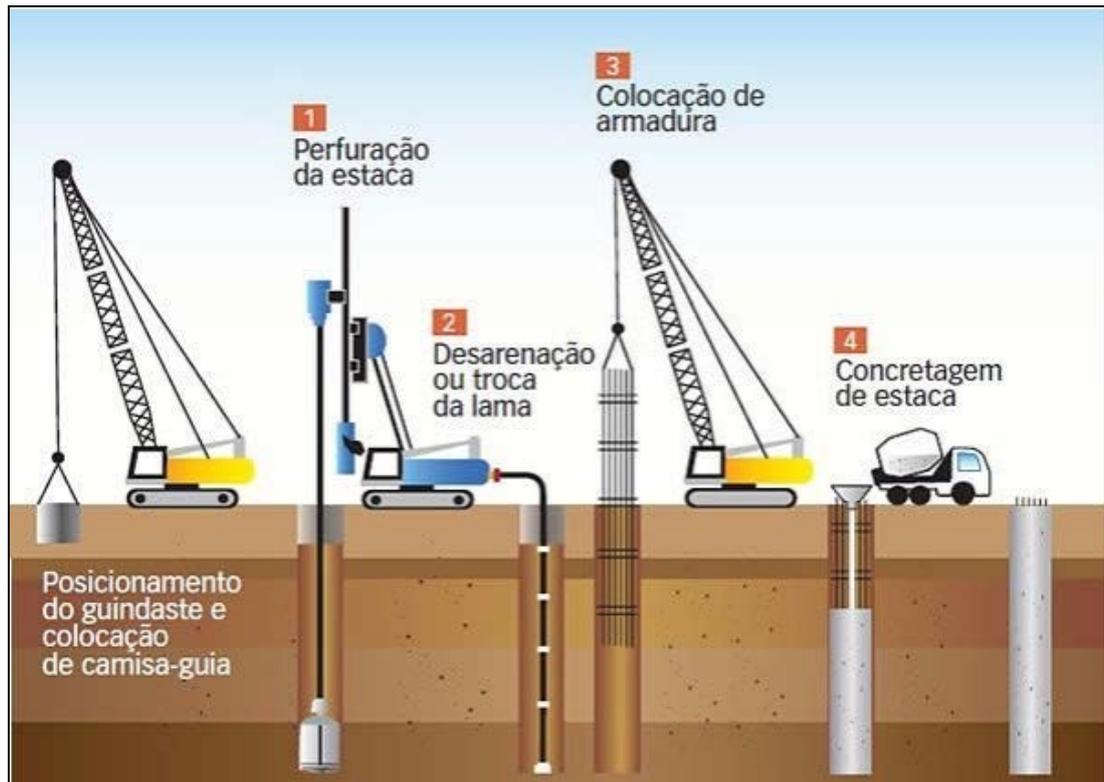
Processo Construtivo Estaca Escavada.
